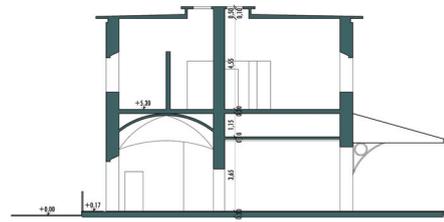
Sezione trasversale B-B del Museo della Ferrovia
